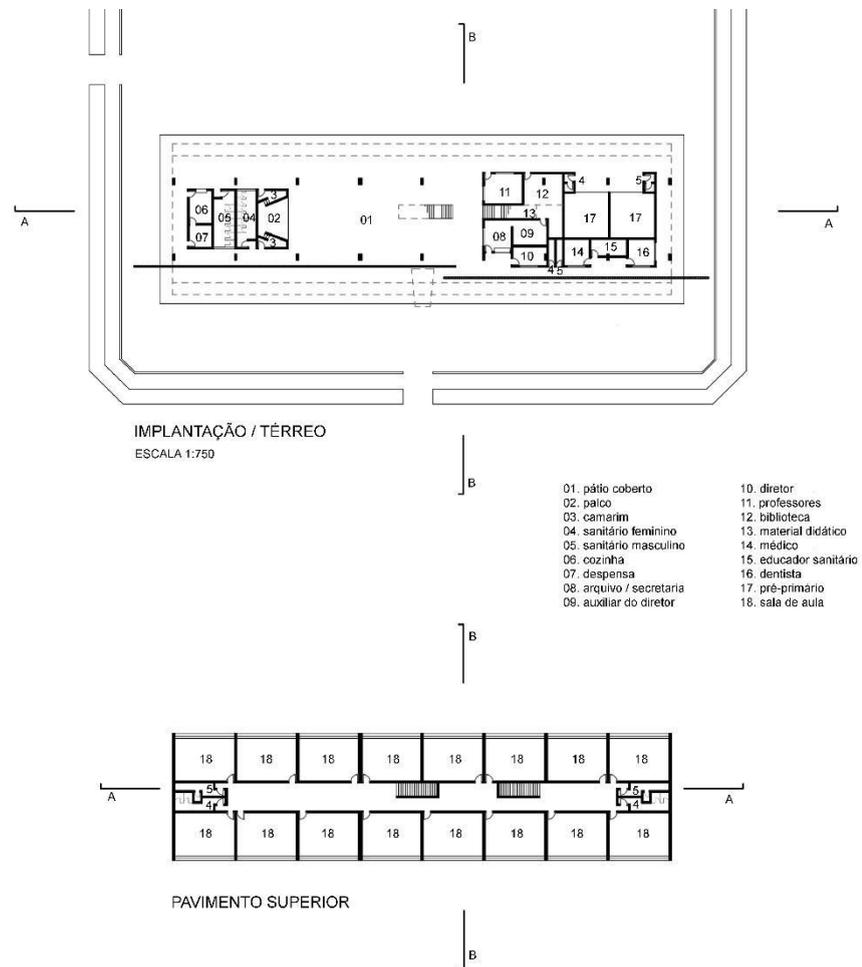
Planta dos pavimentos térreo e superior. Fonte: Acervo ArtArqBr.
